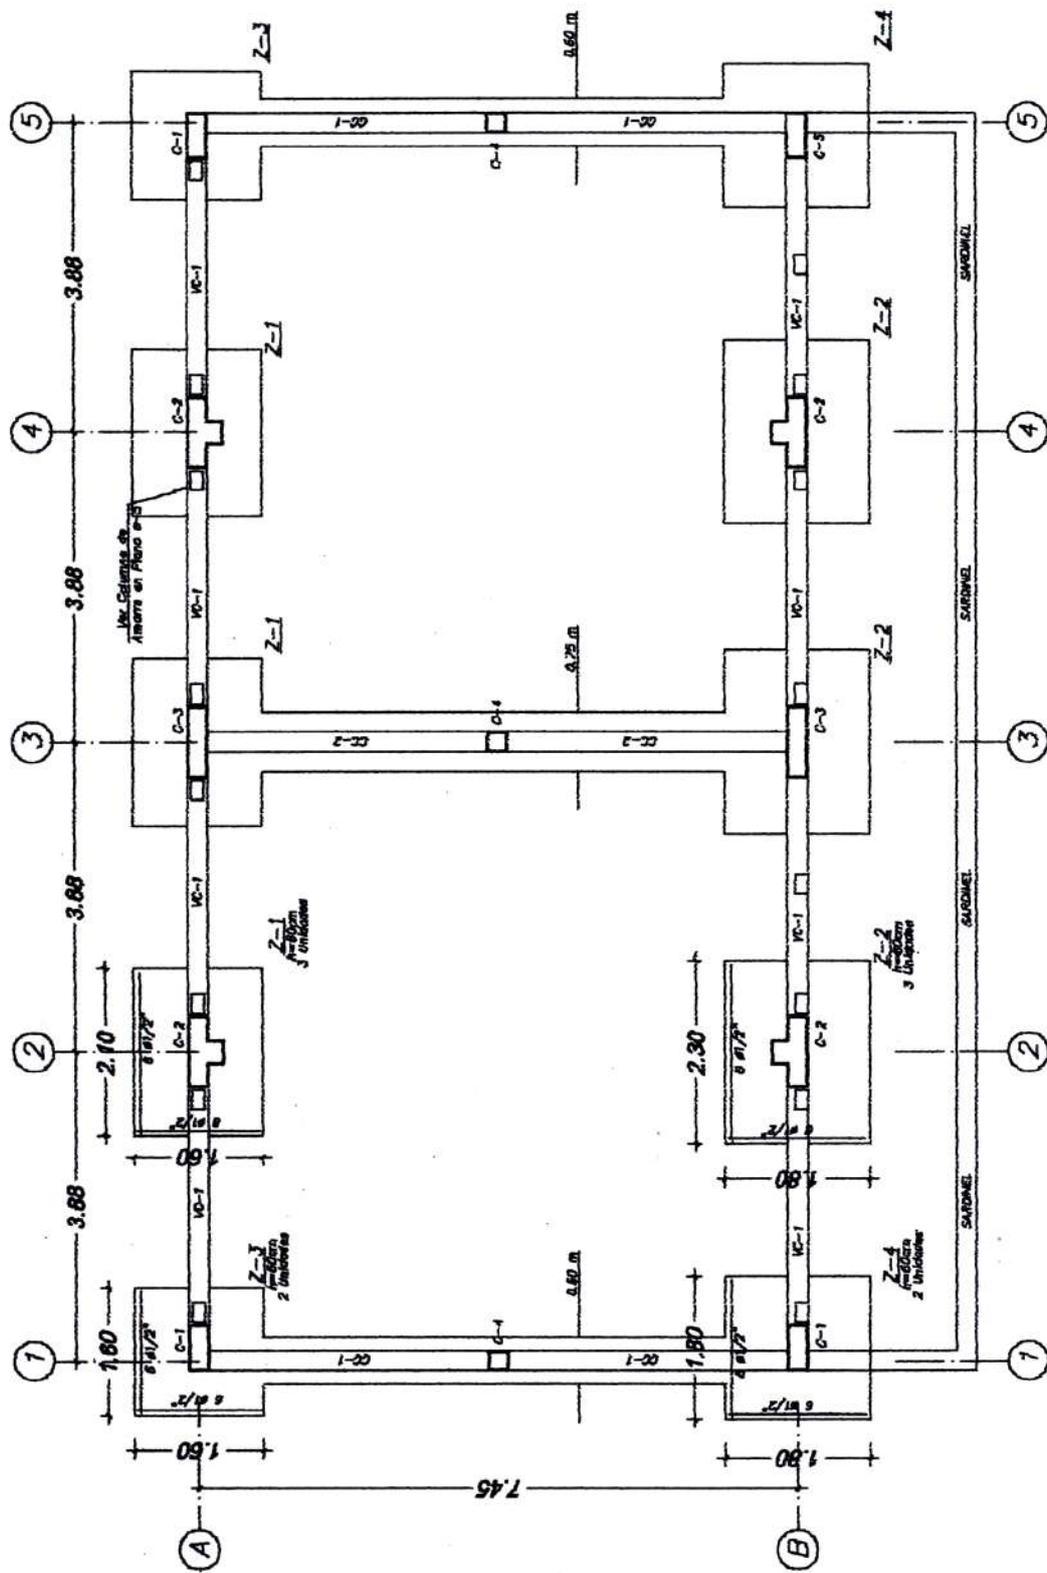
PLANTA DE CIMENTACION 2 AULAS-2 PISOS (CAPACIDAD PORTANTE TERRENO 1.5 – 1.99 Kg/cm²)
